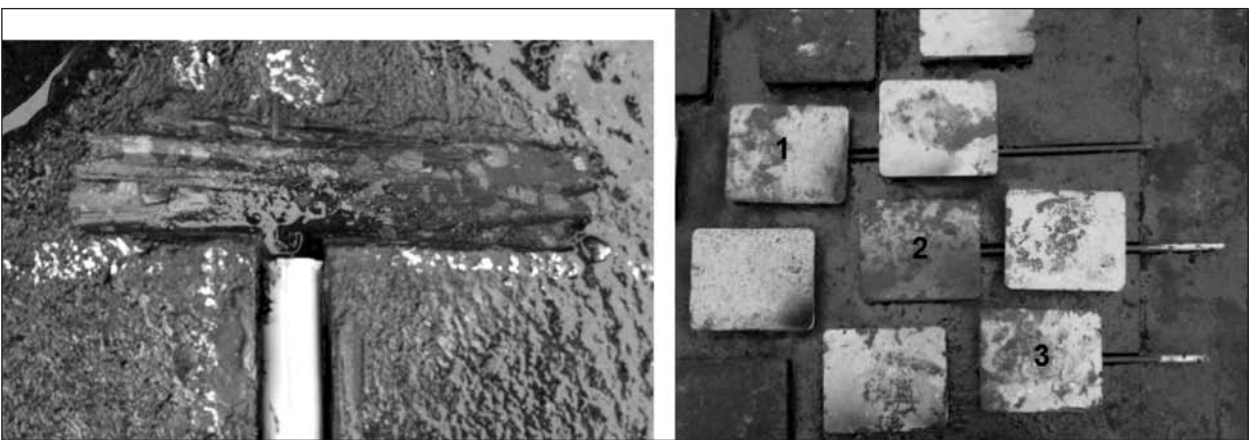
Aussparung (links) und Lage der Führungsrohre (rechts)
